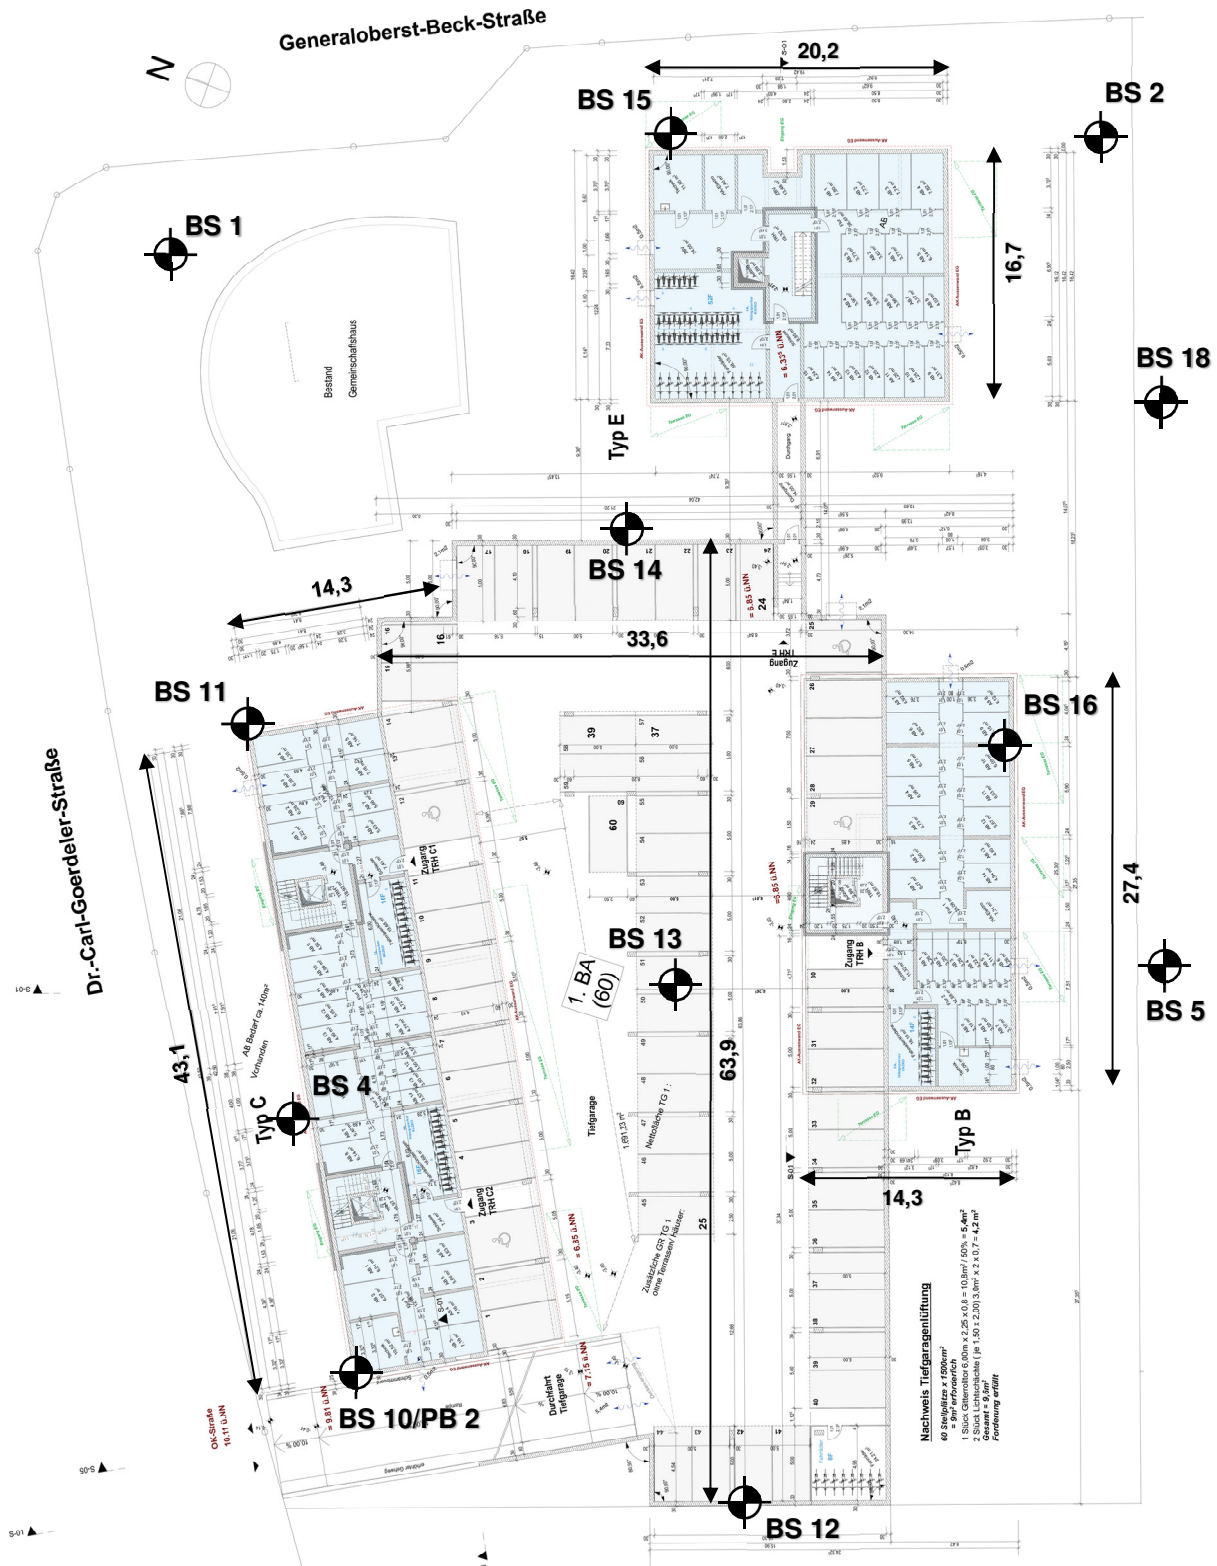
Grundriss TG/KG im 1. BA, M 1:500
